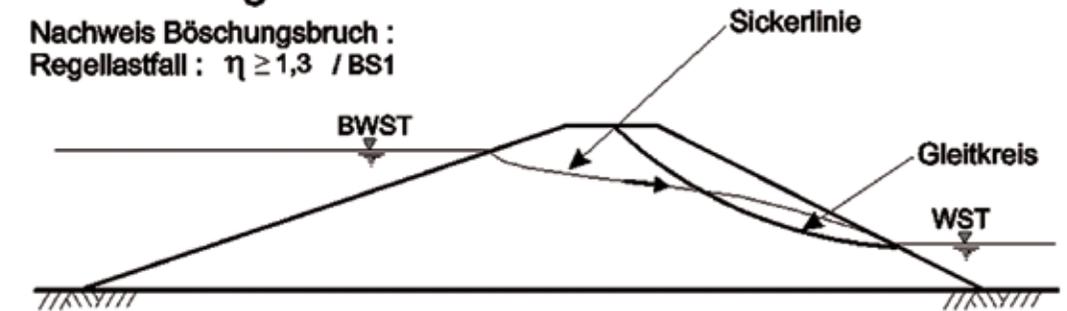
Lastfall: Durchsickerung des Dammkörpers bei Vollstau ohne Strömungsdruck (BS 1). Nachweis Böschungsbruch luftseitig
